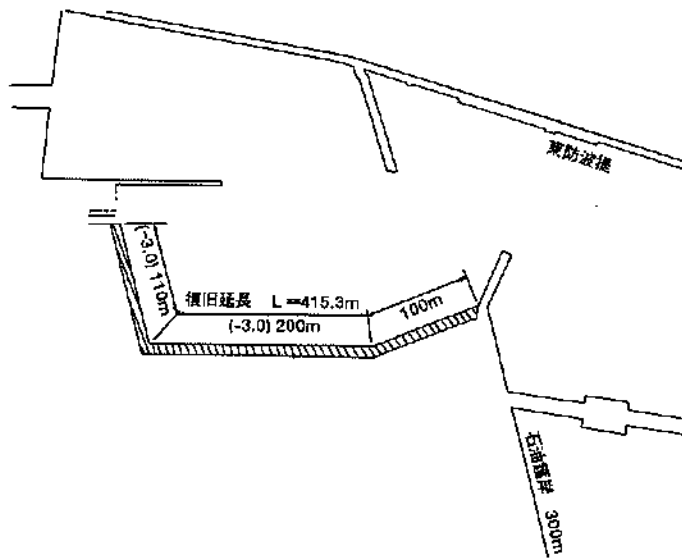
被災狀況平面図 (船溜・漁港地区, ㊸~㊹物揚場(-3.0m))
